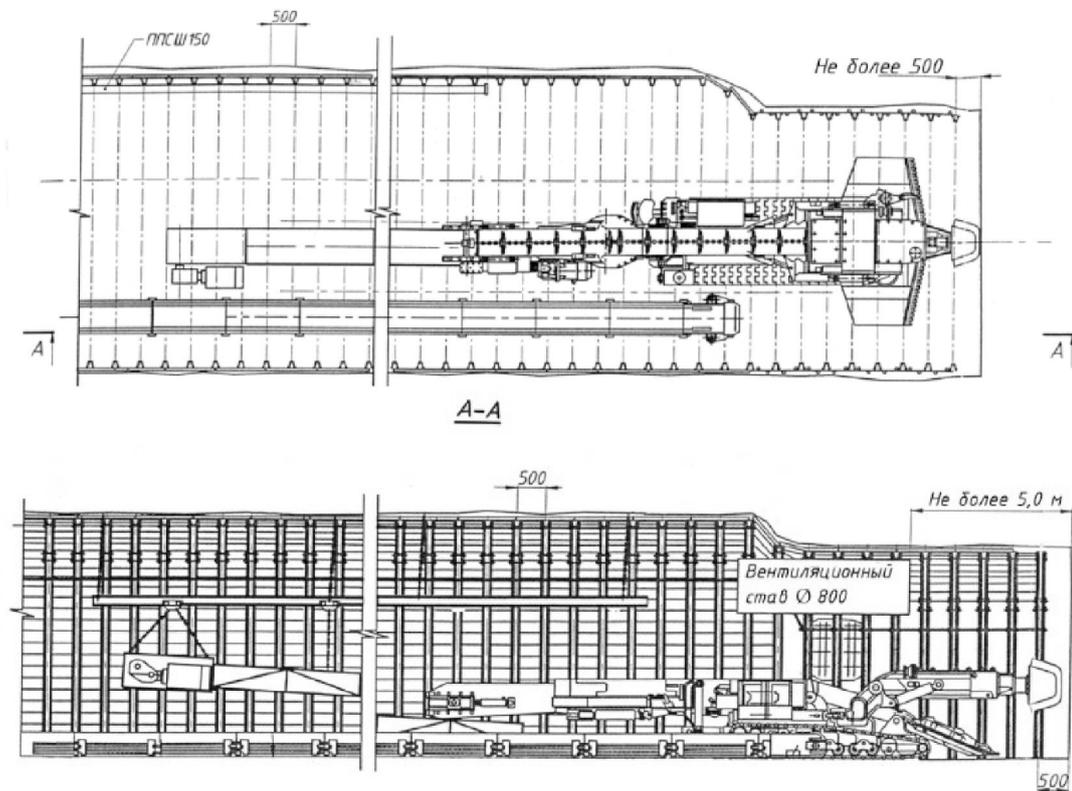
Схема проведения горной выработки комбайном 4ПП-2
